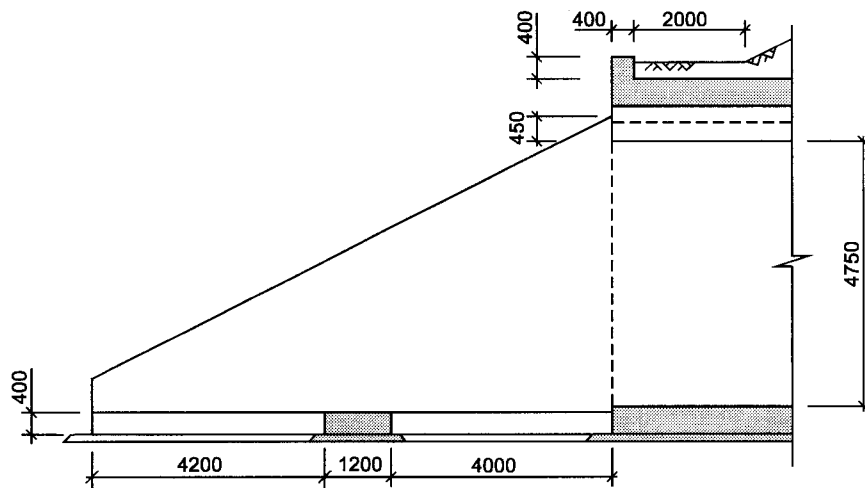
Vingemur normalt på kulvertvegg for kulvert type 1, armering.
